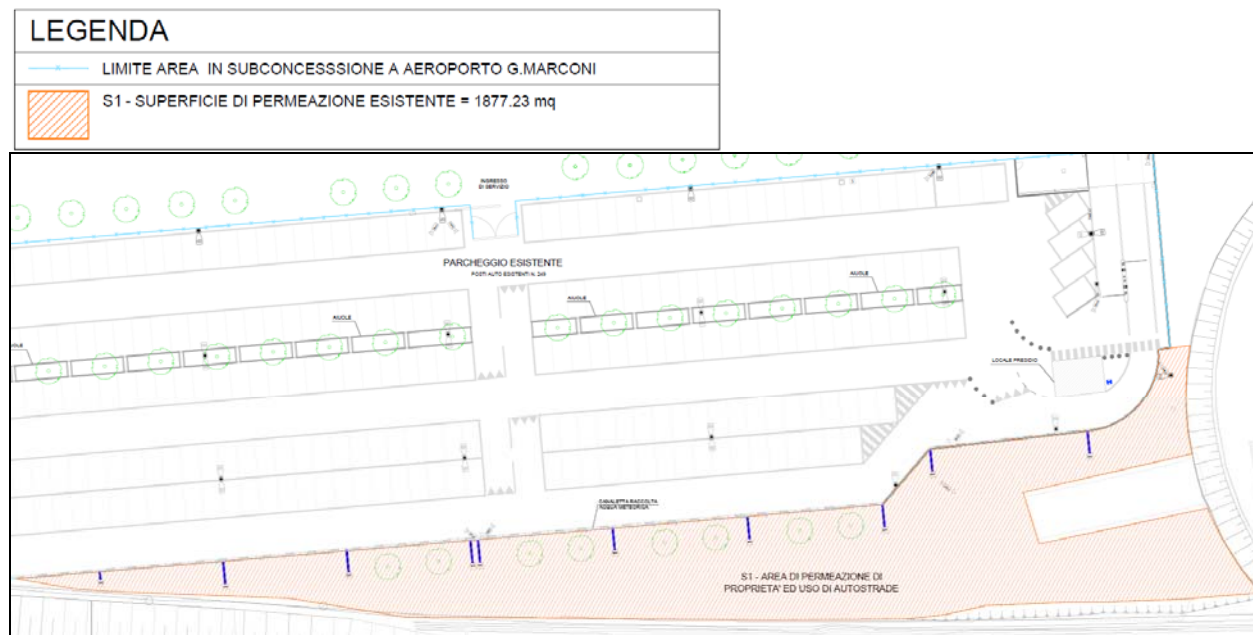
stralcio Tav. EA01: stato attuale – planimetria
